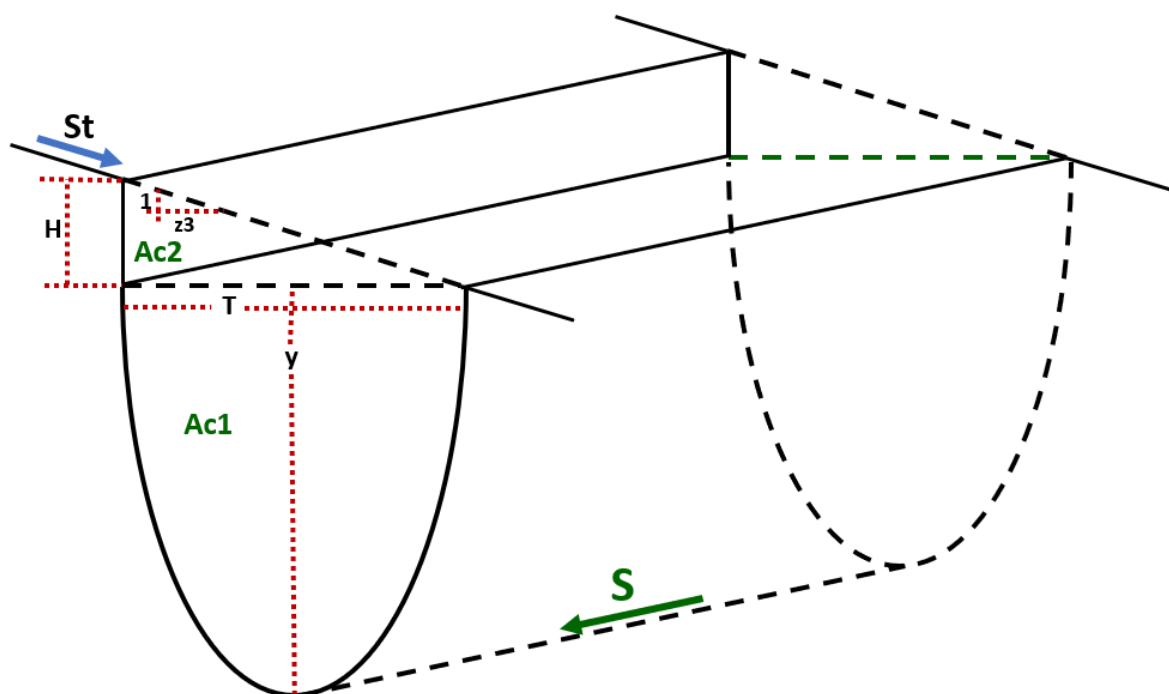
Acequia de ladera con sección parabólica según sin talud en la pared del terreno donde se construye
